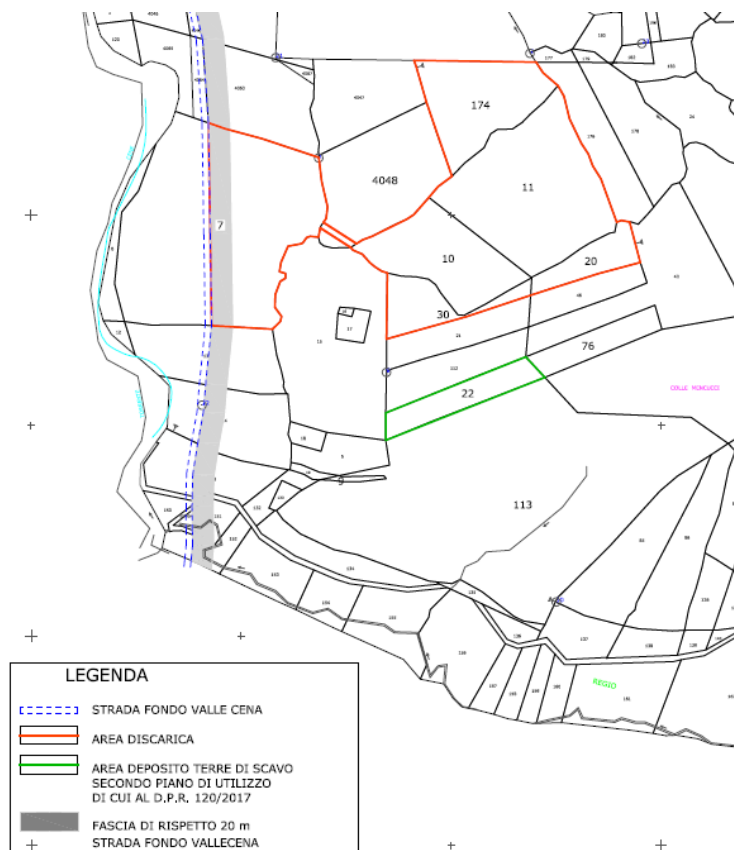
Stralcio planimetrico con fascia di rispetto dalla strada comunale
